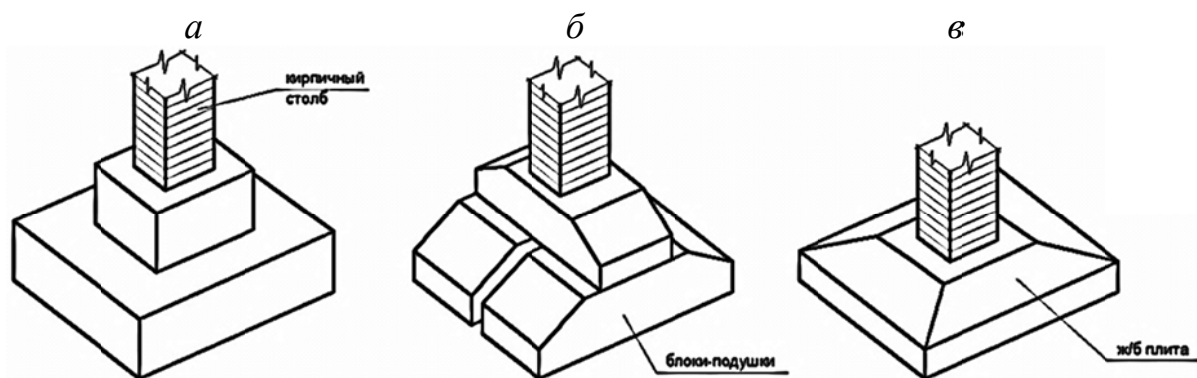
Столбчатые фундаменты под кирпичную колонну: а – монолитный; б – сборный из железобетонных блоков-подушек; в – сборный из железобетонного блока-плиты
